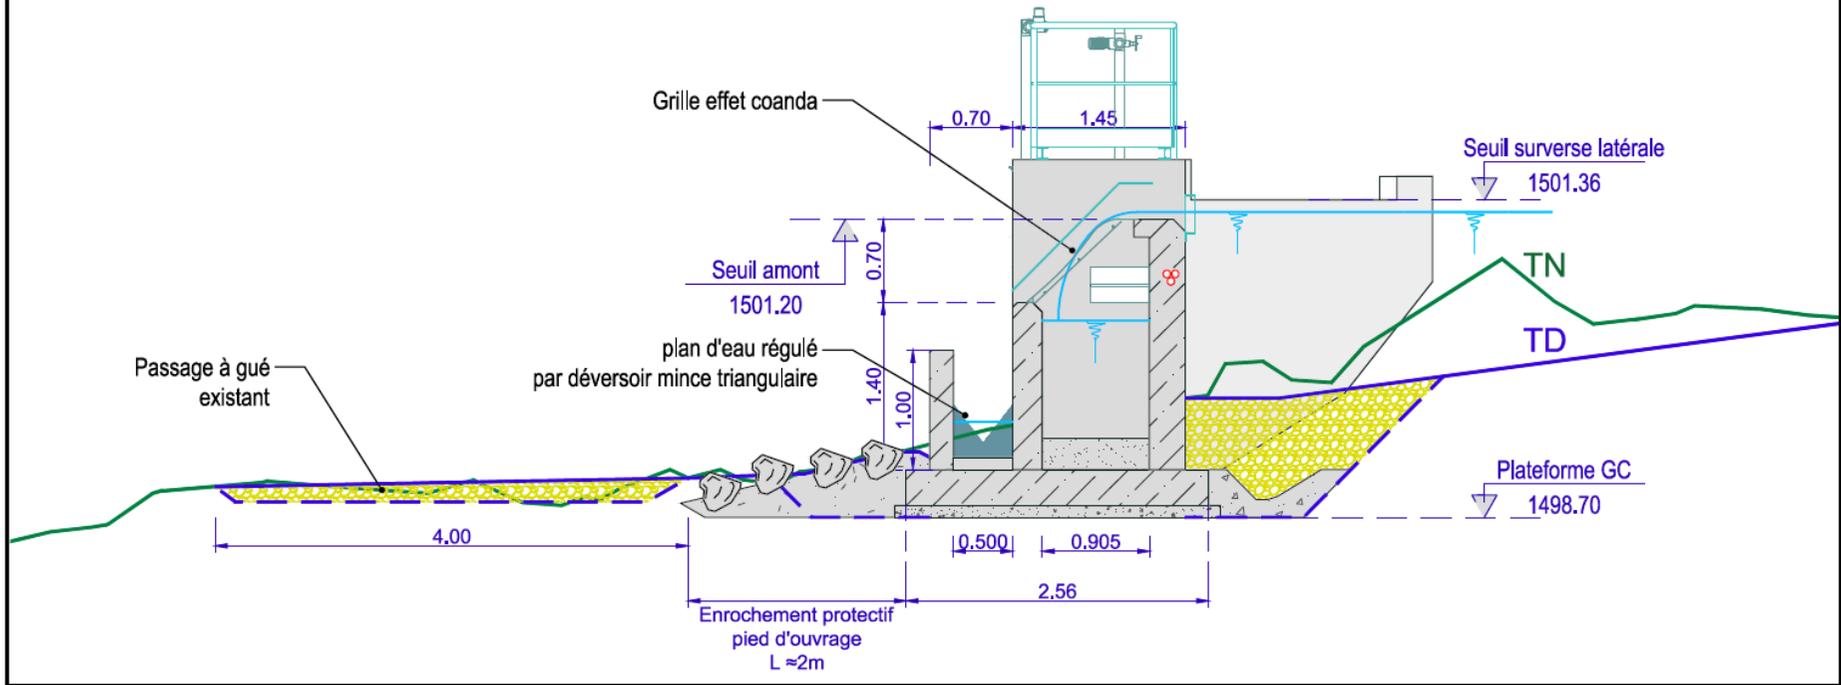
Plan en coupe de la prise d'eau (Alpétudes, APD)
